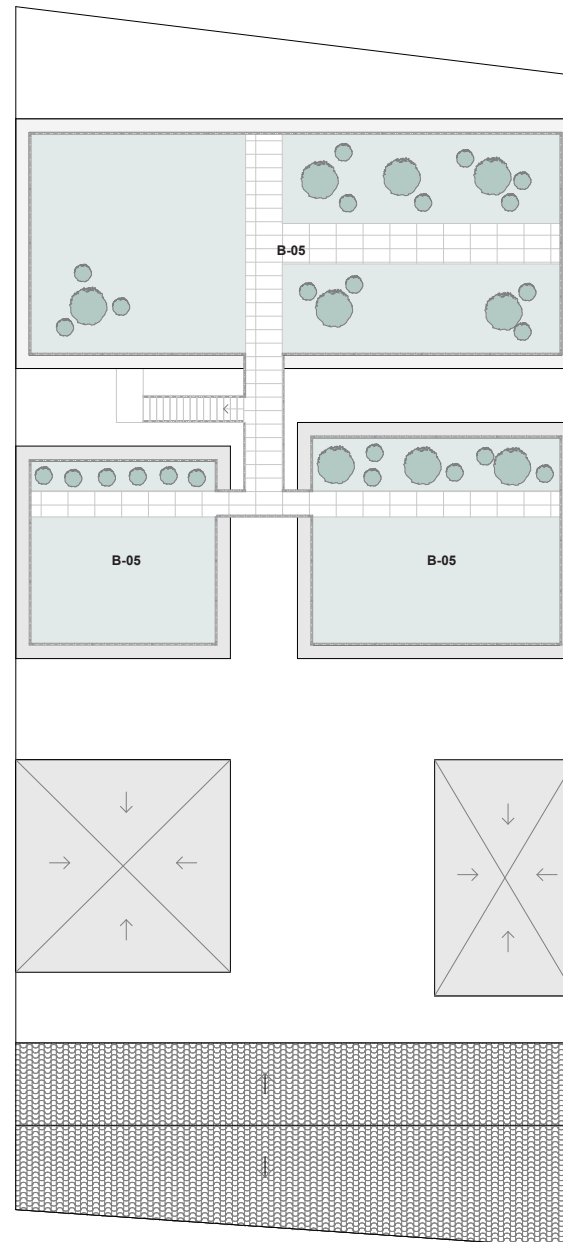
Planta de Cubiertas. Elaborado por Grupo de Tesis.
